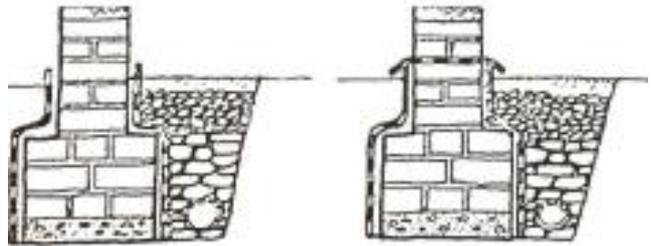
Utilização de telas impermeabilizantes para se proteger as fundações. (Houben & Guillaud, 1989, p. 248)
